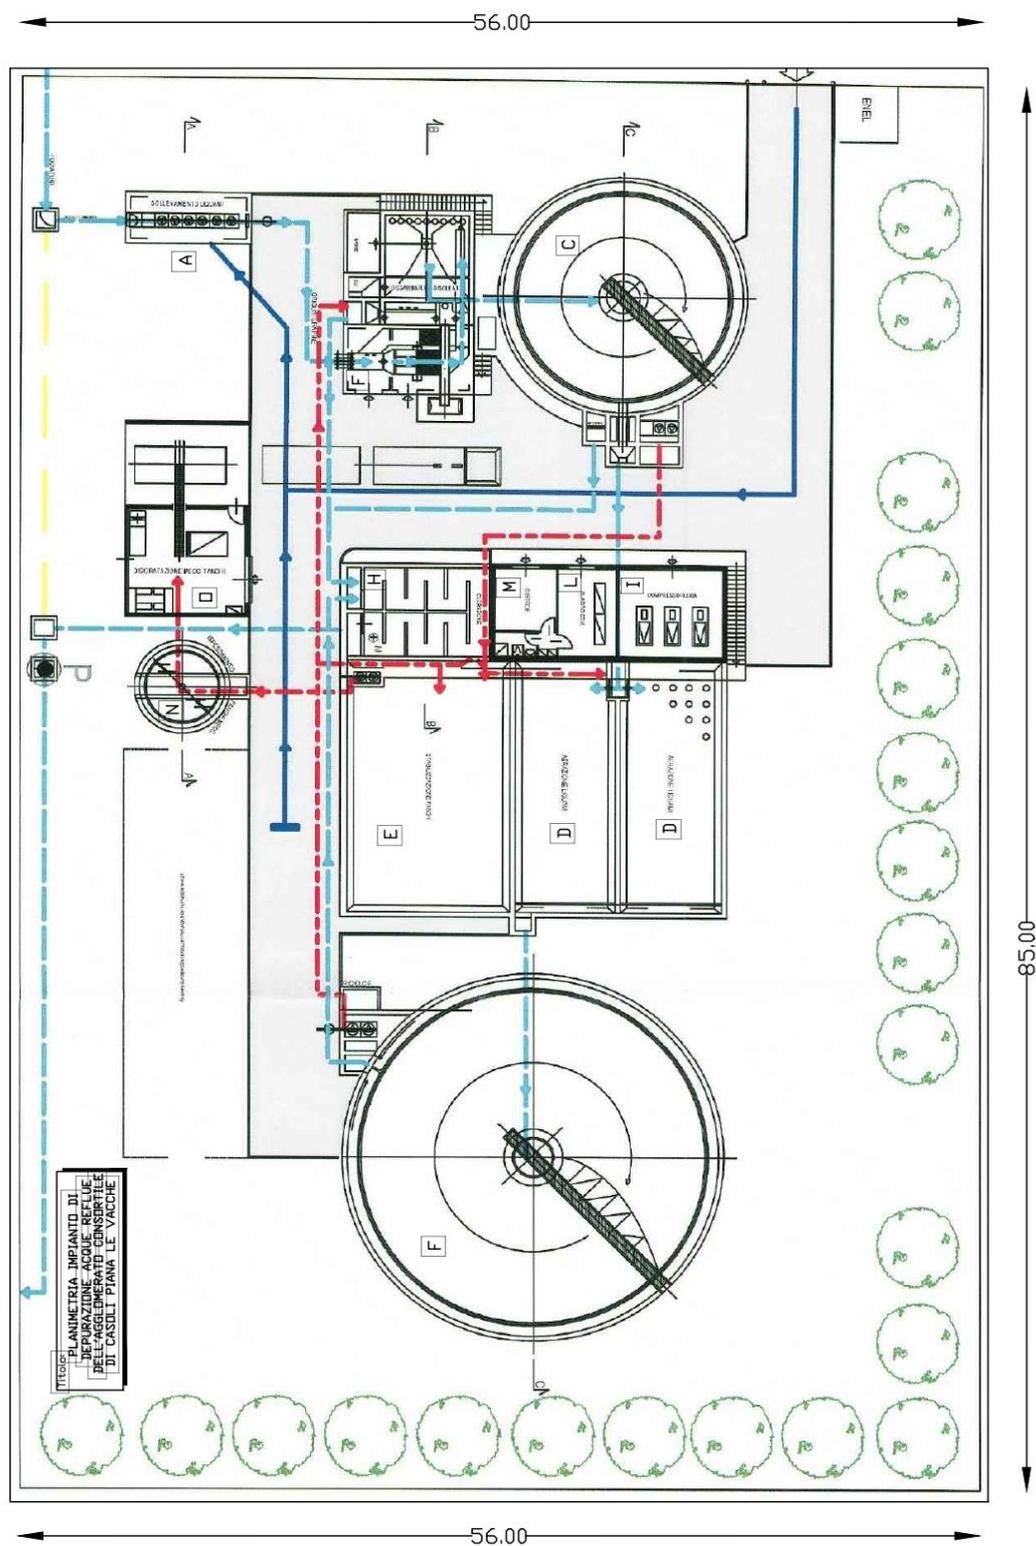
planimetria dell'impianto di depurazione di Casoli (CH)
